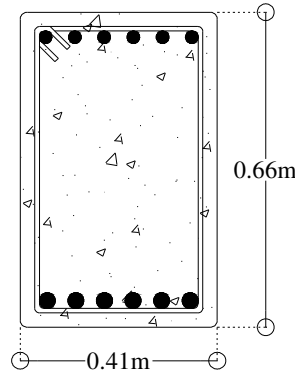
Viga de concreto reforzado (Ejemplo 1)
